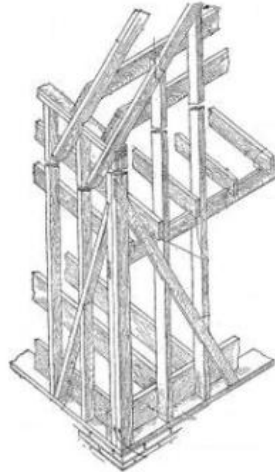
Estrutura em Ballon Frame. Fonte: (Vaz, 2008).
